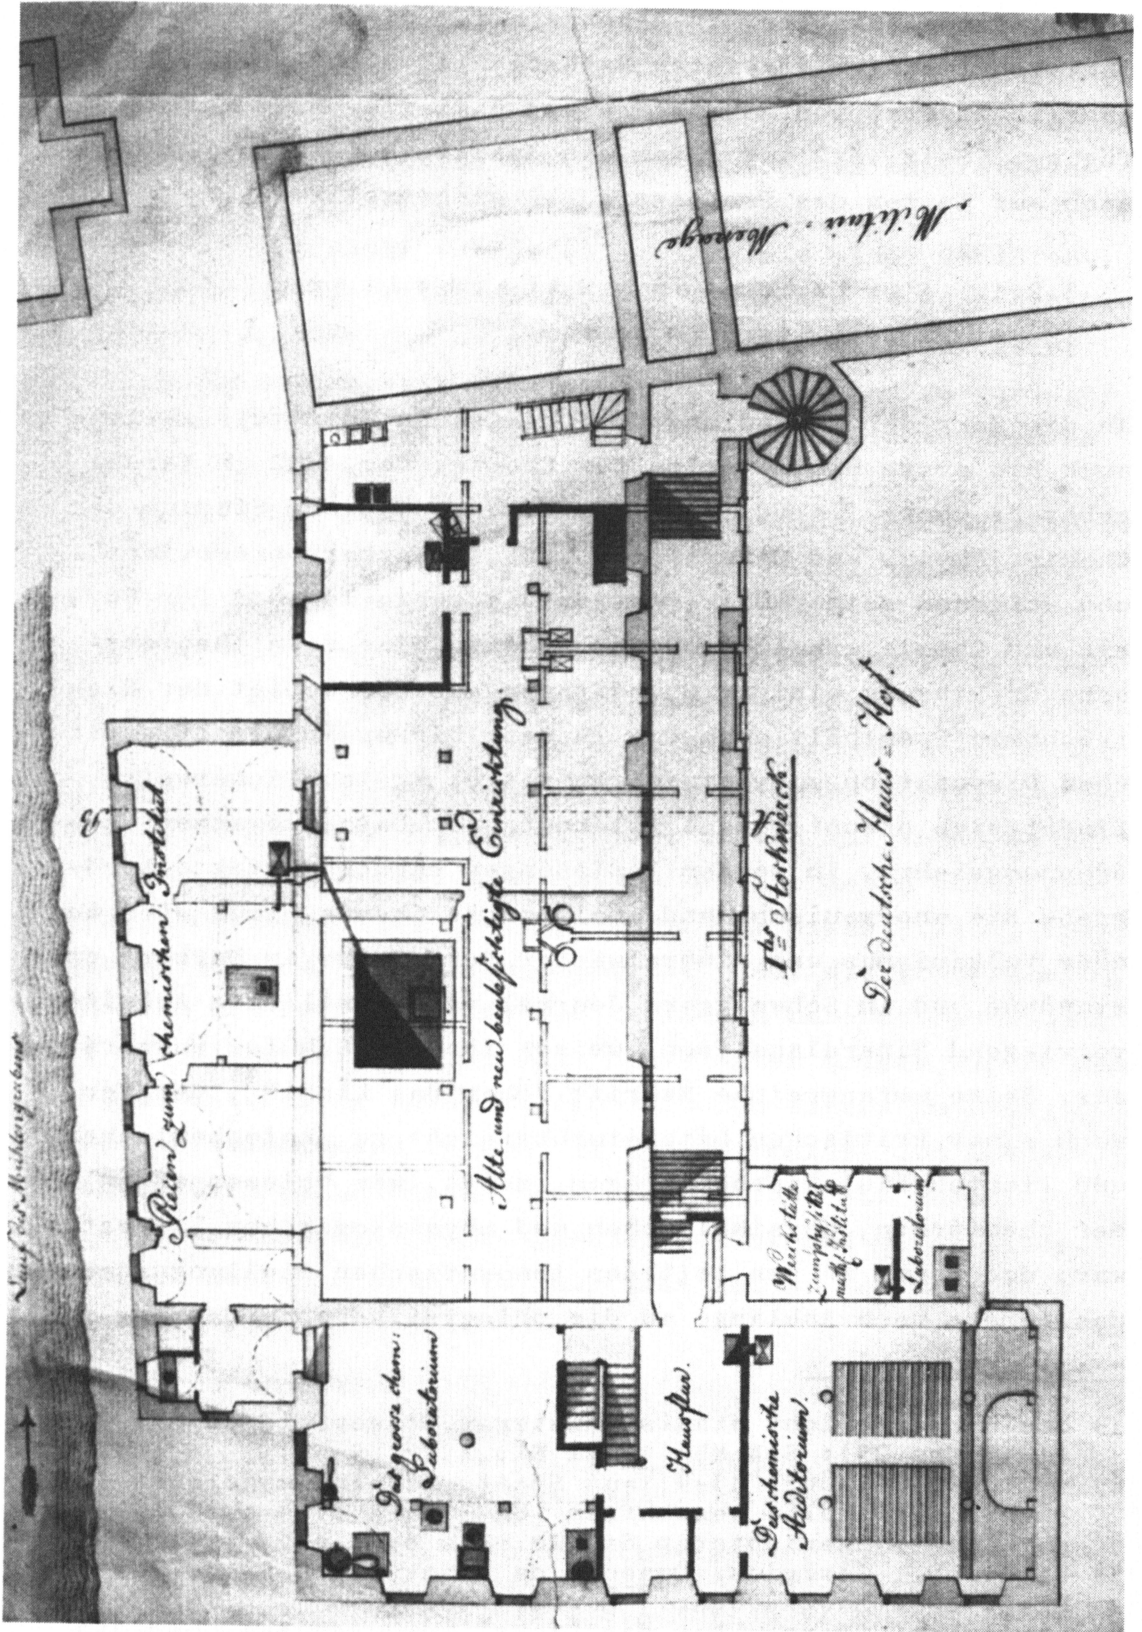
Deutsches Haus, Marburg: Grundriß des 1. Stockwerks. Nach einem undatierten, kolorierten Plan, ca. 1825 - 1833.
